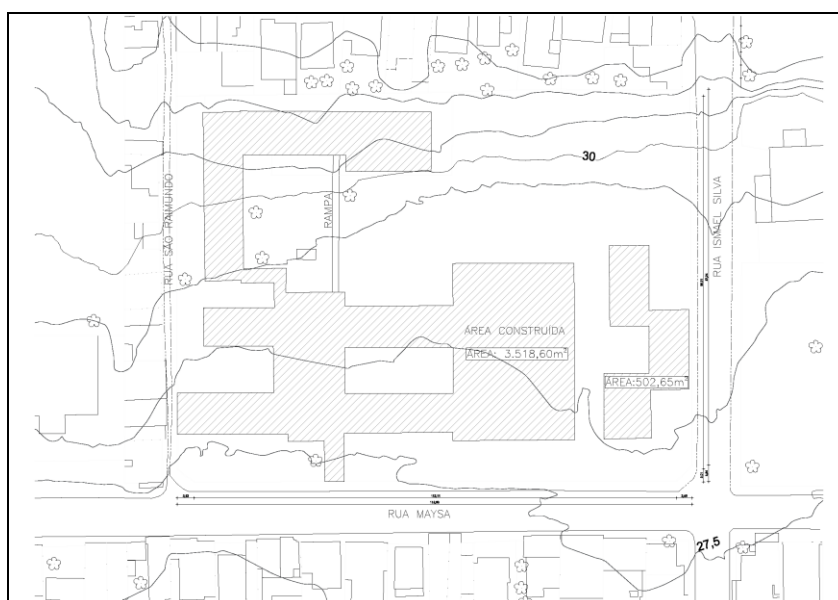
Planta de Situação. Fonte: SEINF-COPROJ.
